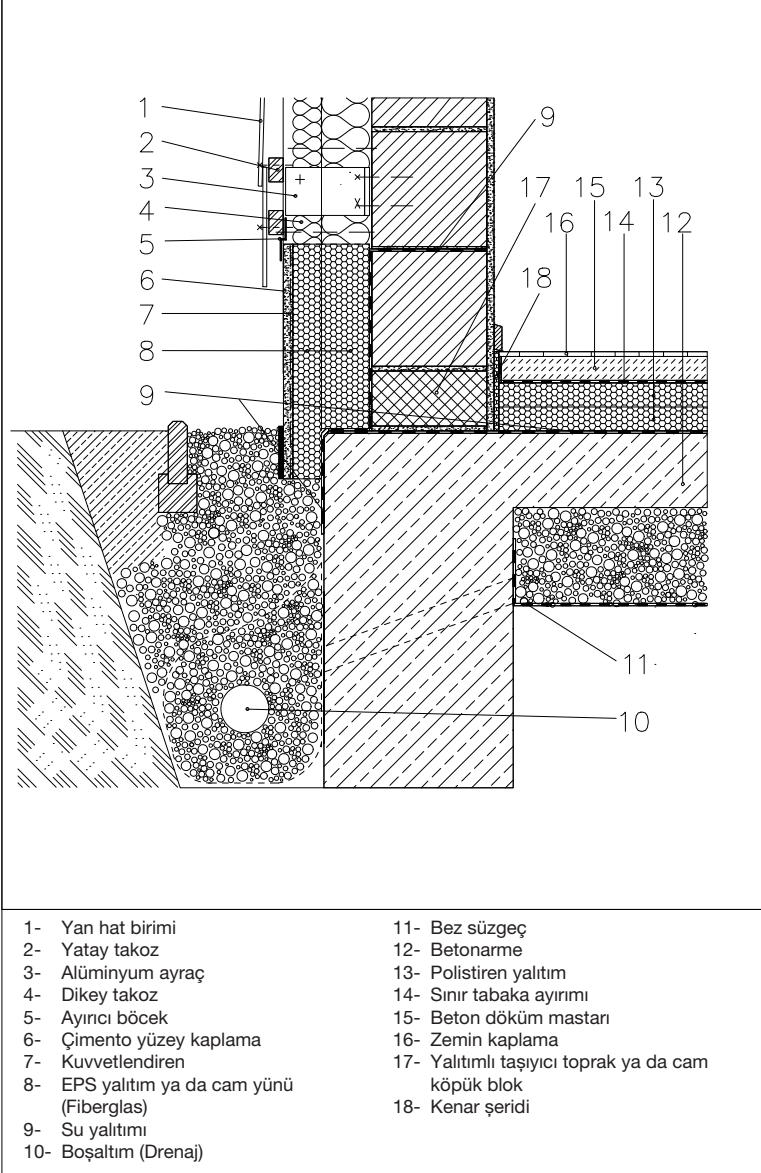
Taban Yalıtım Detayı-Beton Döşeme Üzerinde Yalıtım (Ölçek 1:10)
